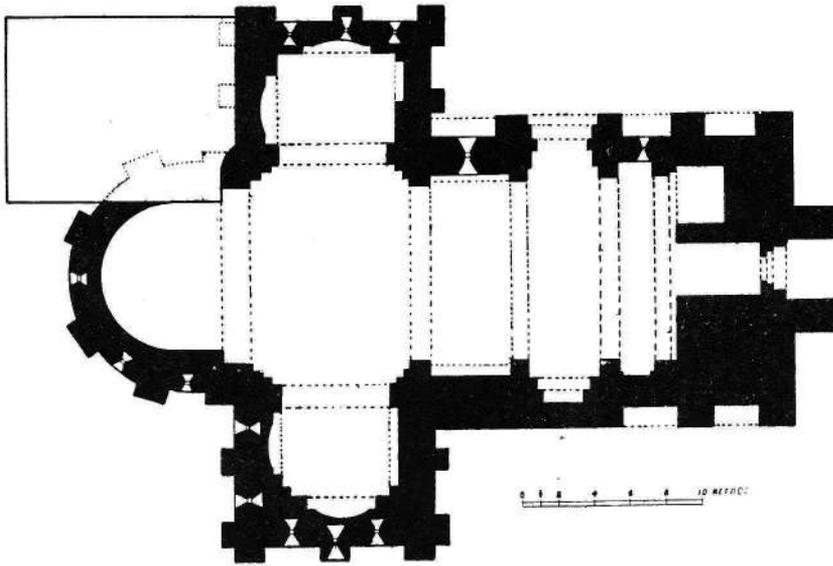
San Pedro de Siresa. Planta de Lamolla.
